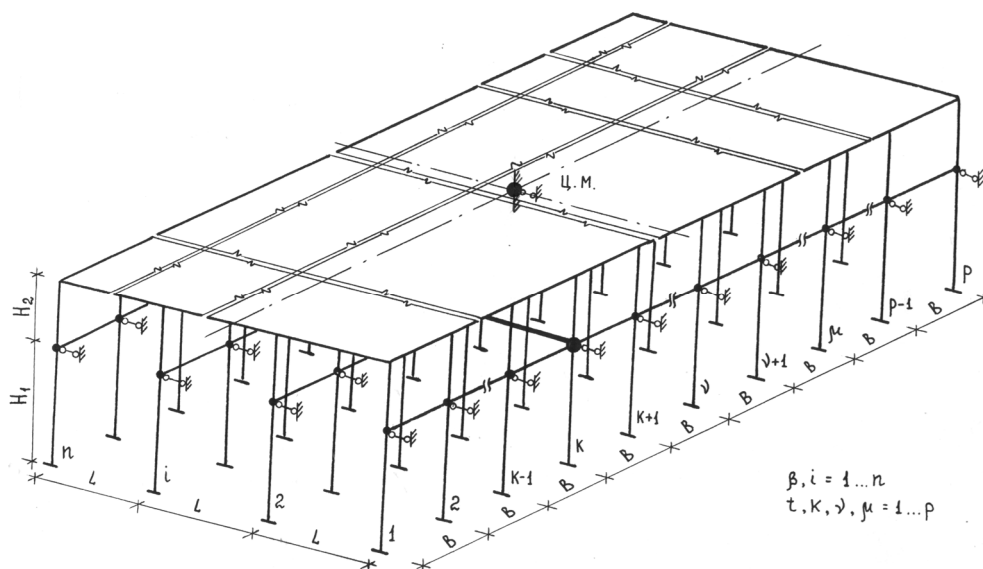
Расчетная схема одноэтажного промышленного здания с жестким в своей плоскости покрытием
